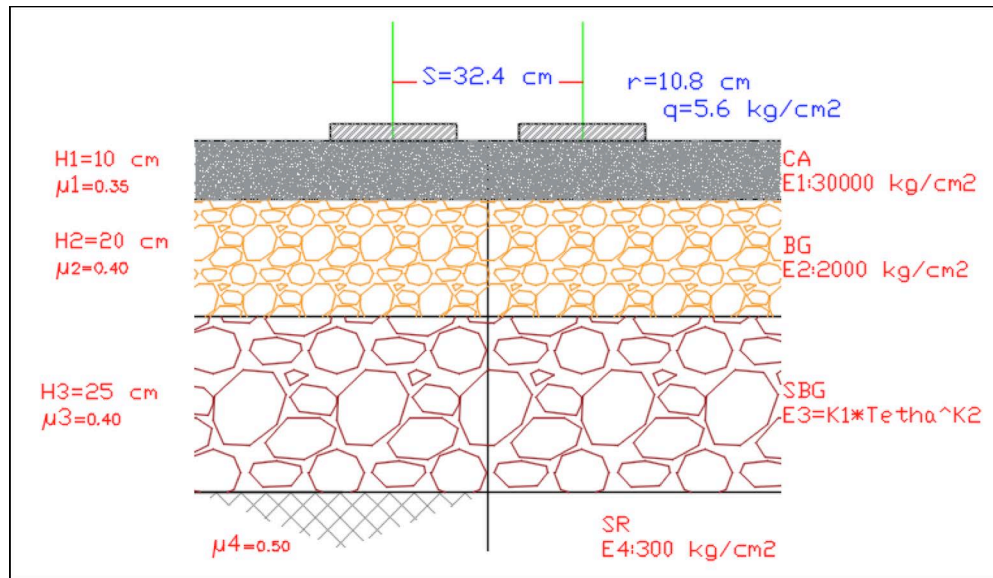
Modelo estructural de pavimento flexible. Fuente: Los Autores
